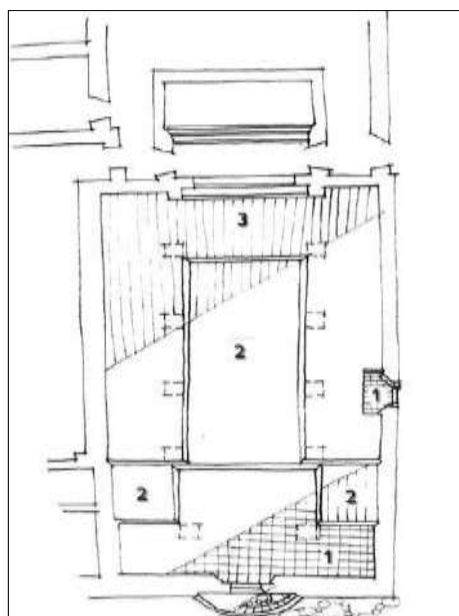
Exemplo de um esboço de planta baixa da nave da Igreja de Nossa Senhora da Assunção.
